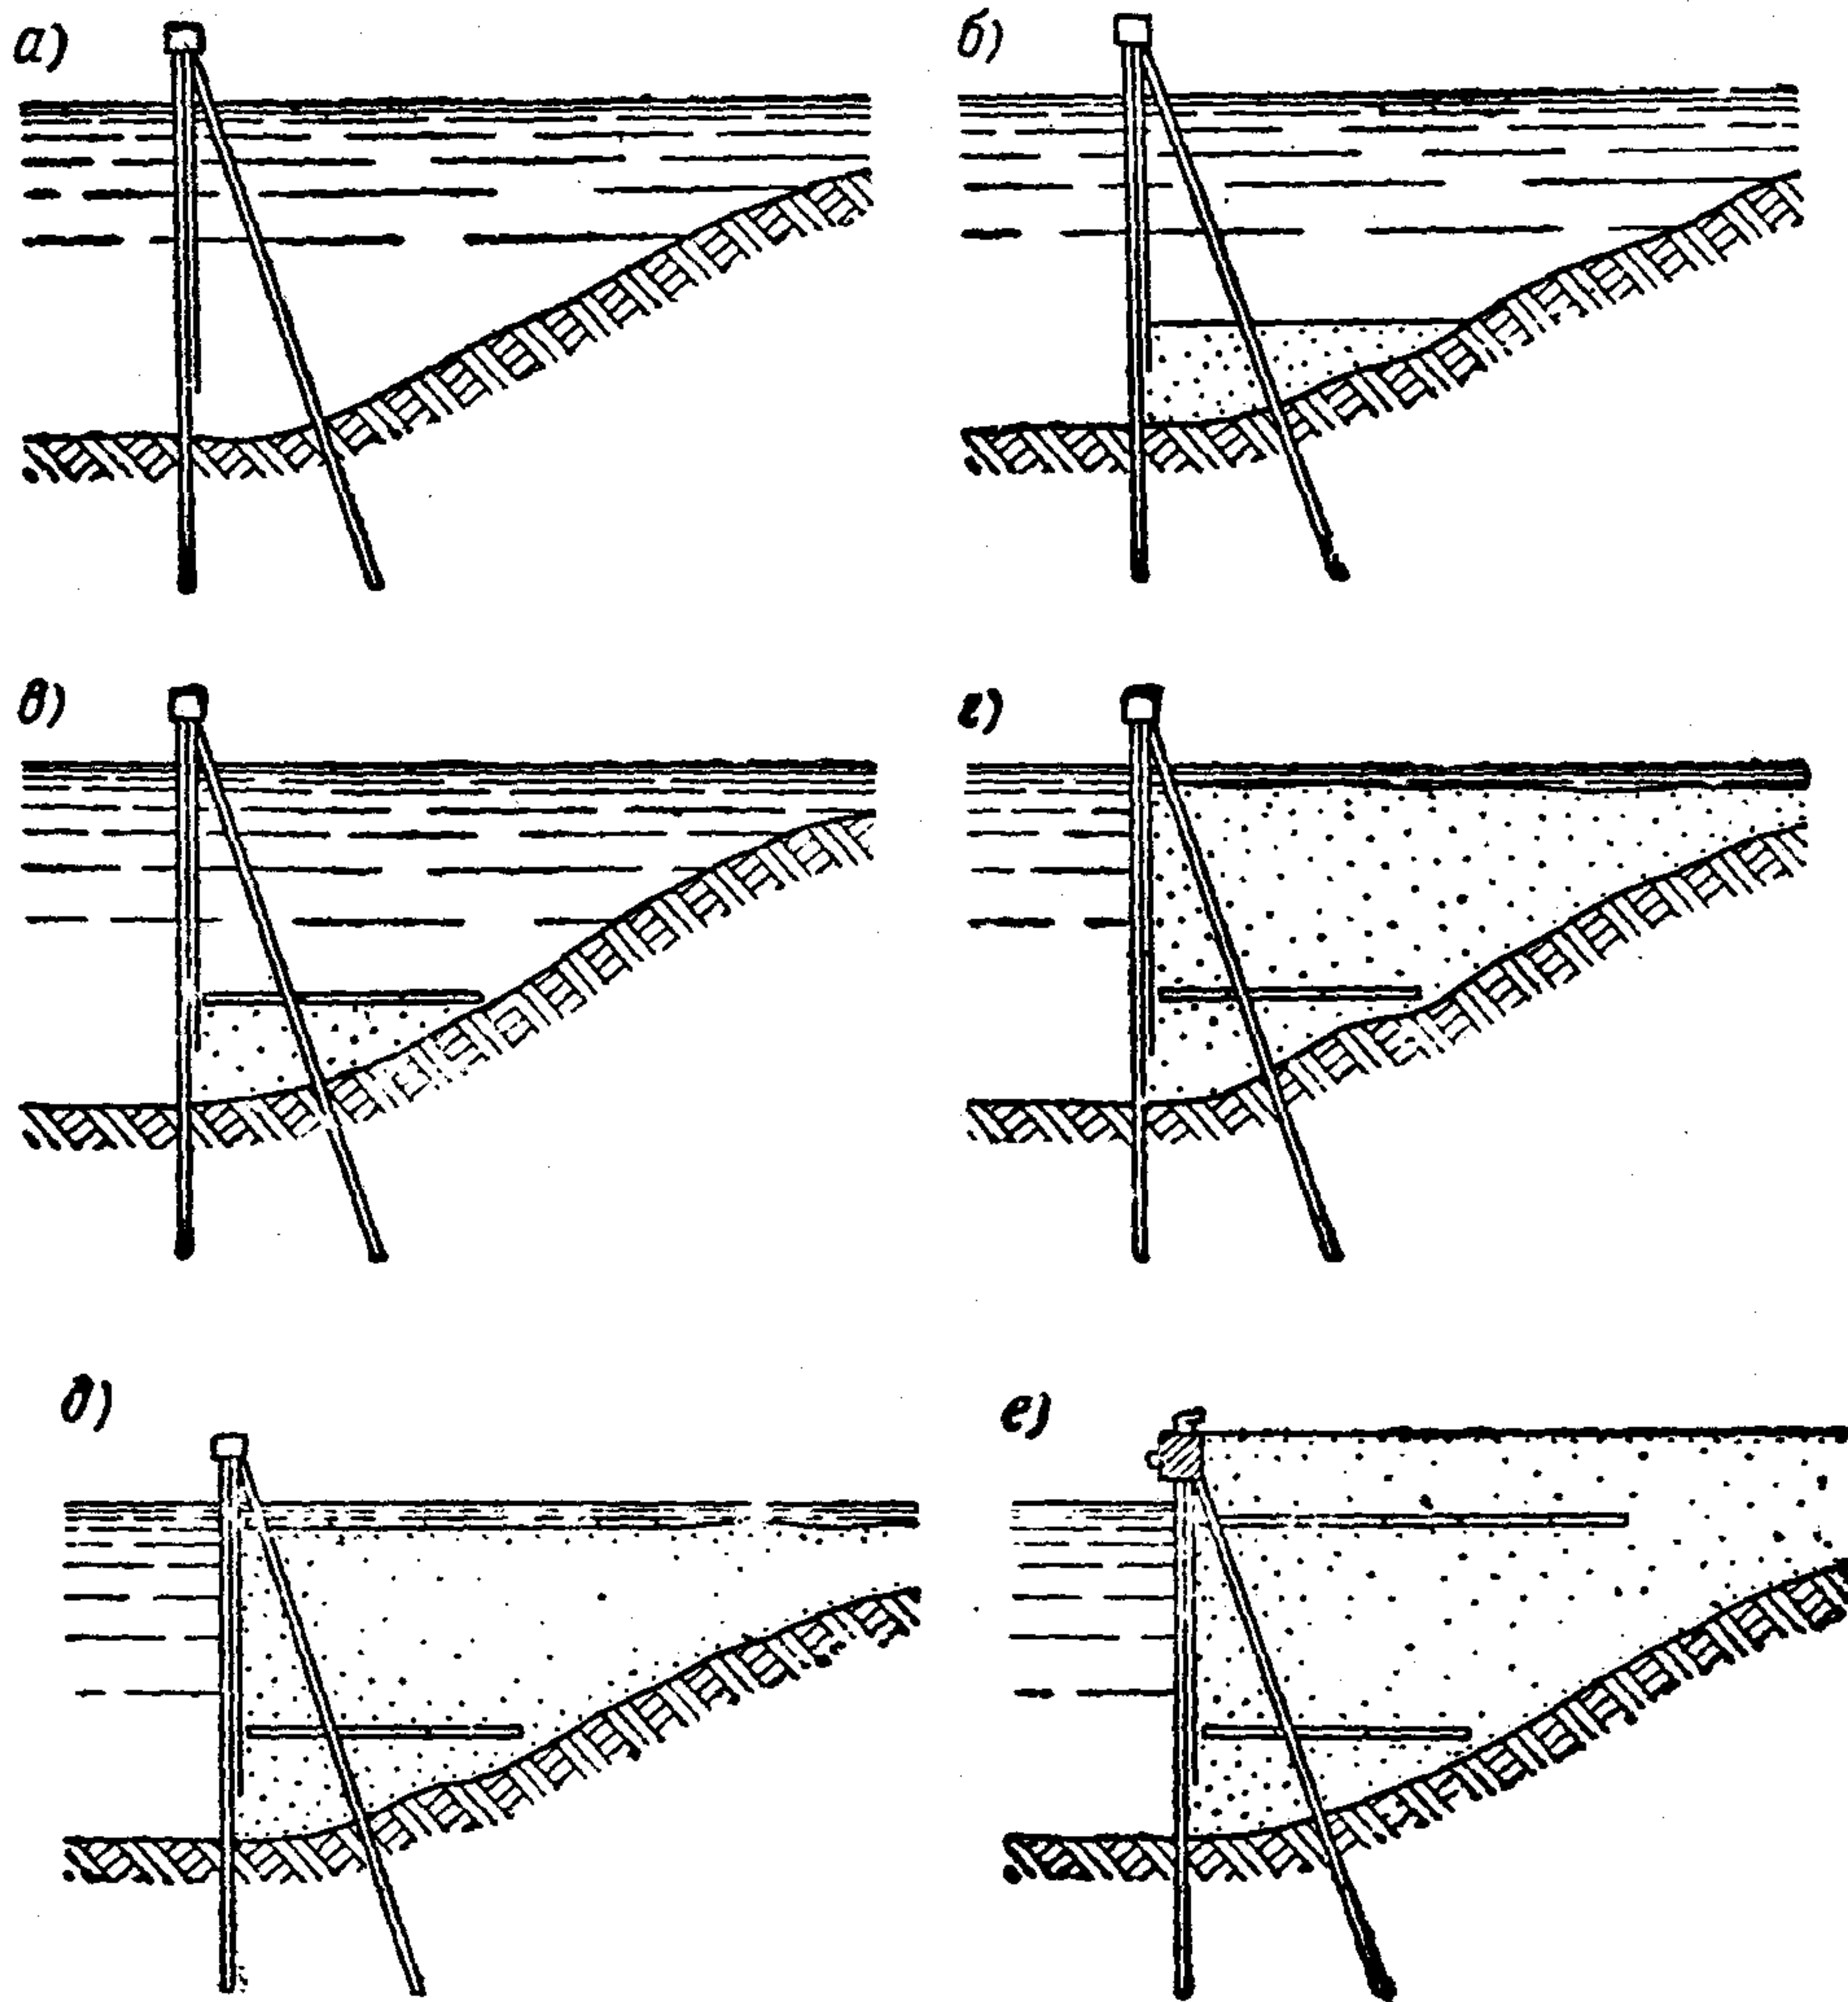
Последовательность работ при устройстве шпунтовой стенки с анкерной на двух уровнях (подкрановые пути на шпальном основании)
